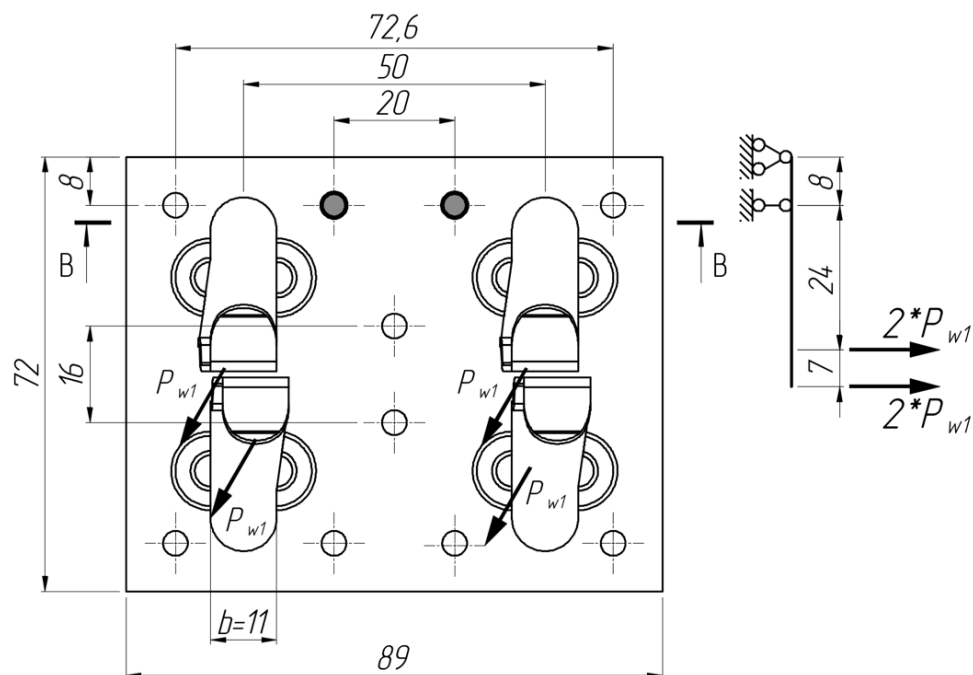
Расчетная схема кляммерной пластины по сечению В – В.
